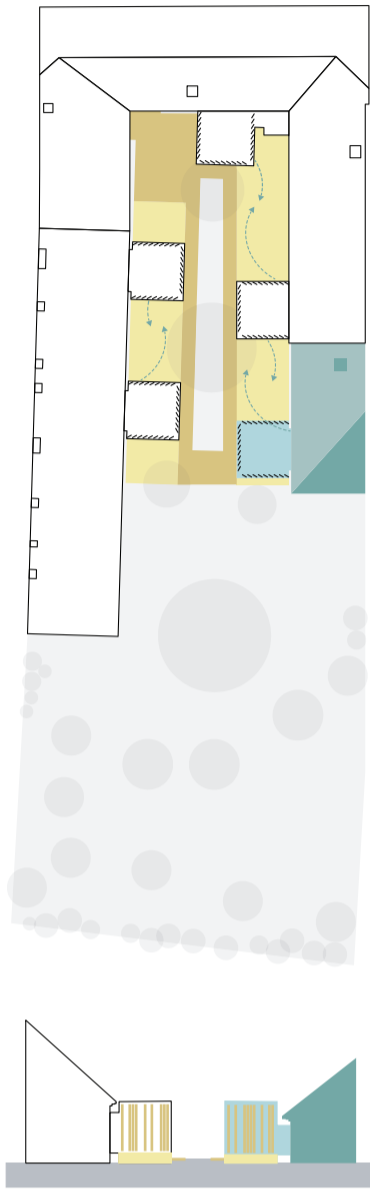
Grundriss und Schnitt | M 1:500
